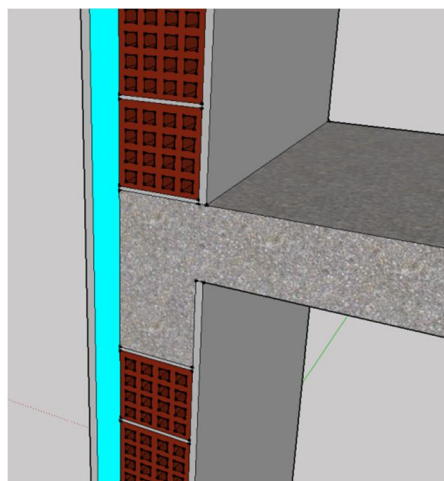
Parede de tijolo simples com isolamento térmico pelo exterior
